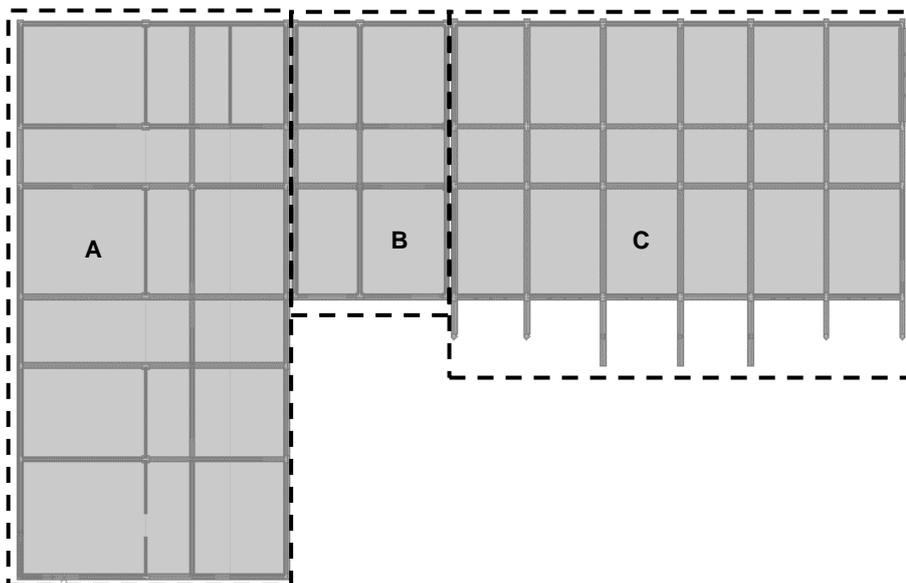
Vista en planta del modelo matemático tridimensional del Bloque 09
